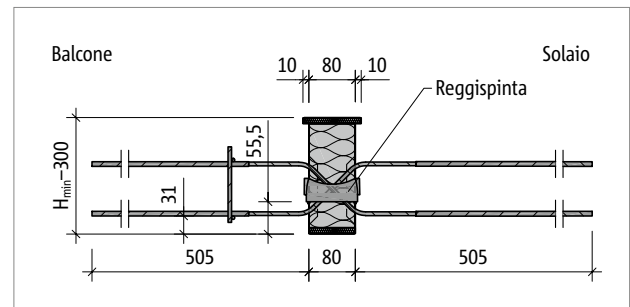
Schöck Isokorb® T tipo QL-VV2 – QL-VV3: sezione del prodotto
